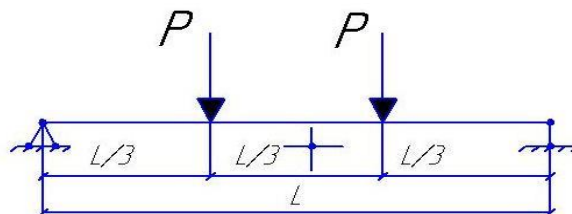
Испытание балки по схеме двухточечного изгиба.
